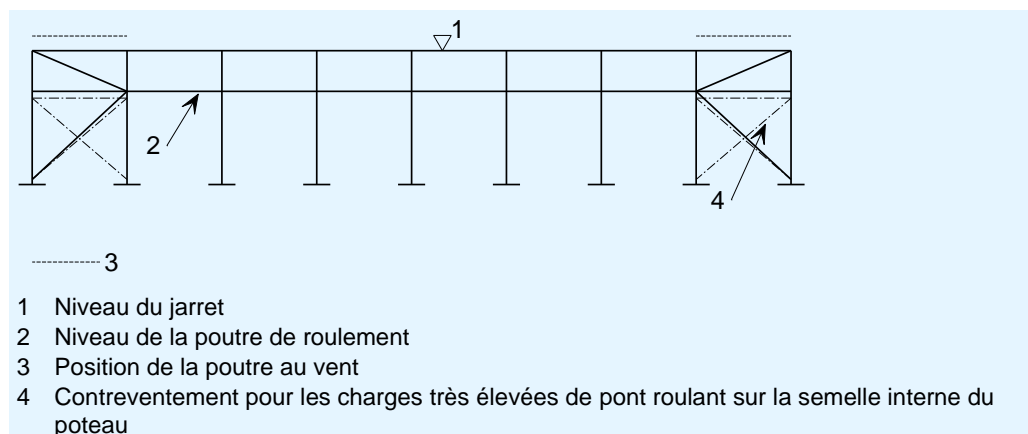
Élévation montrant la position du contreventement additionnel dans le plan de la poutre de roulement
